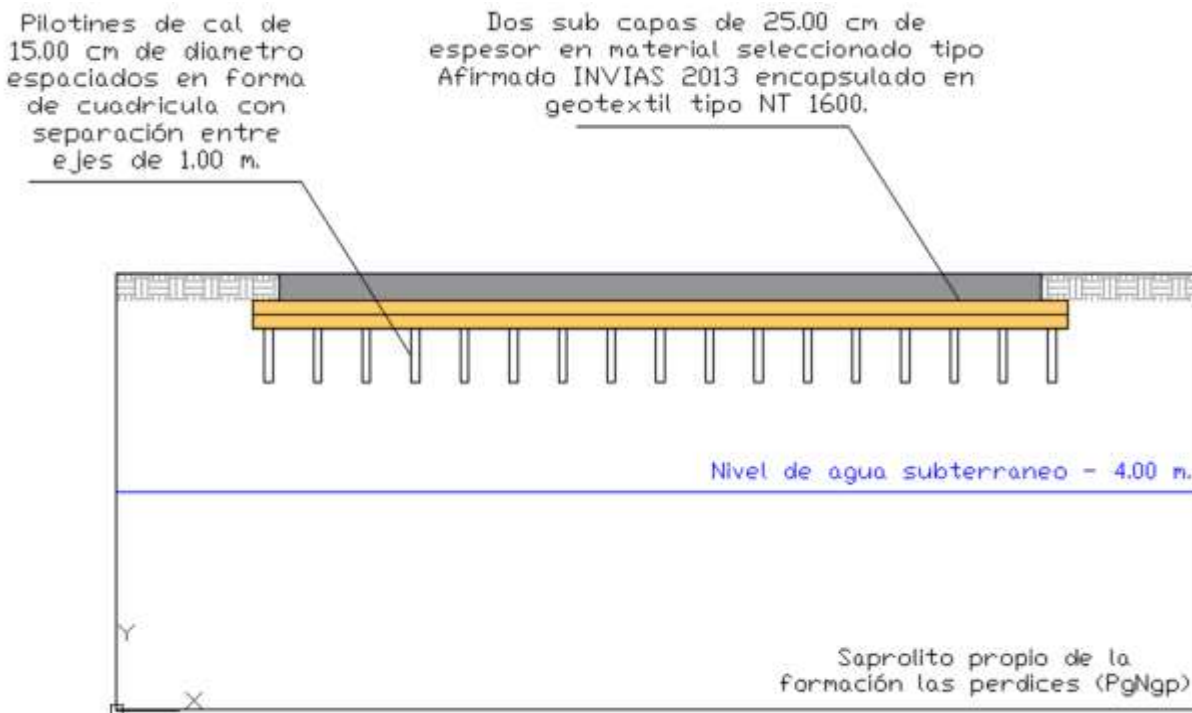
Esquema de sistema de cimentación propuesto para cuarto de máquinas y cuarto eléctrico.
